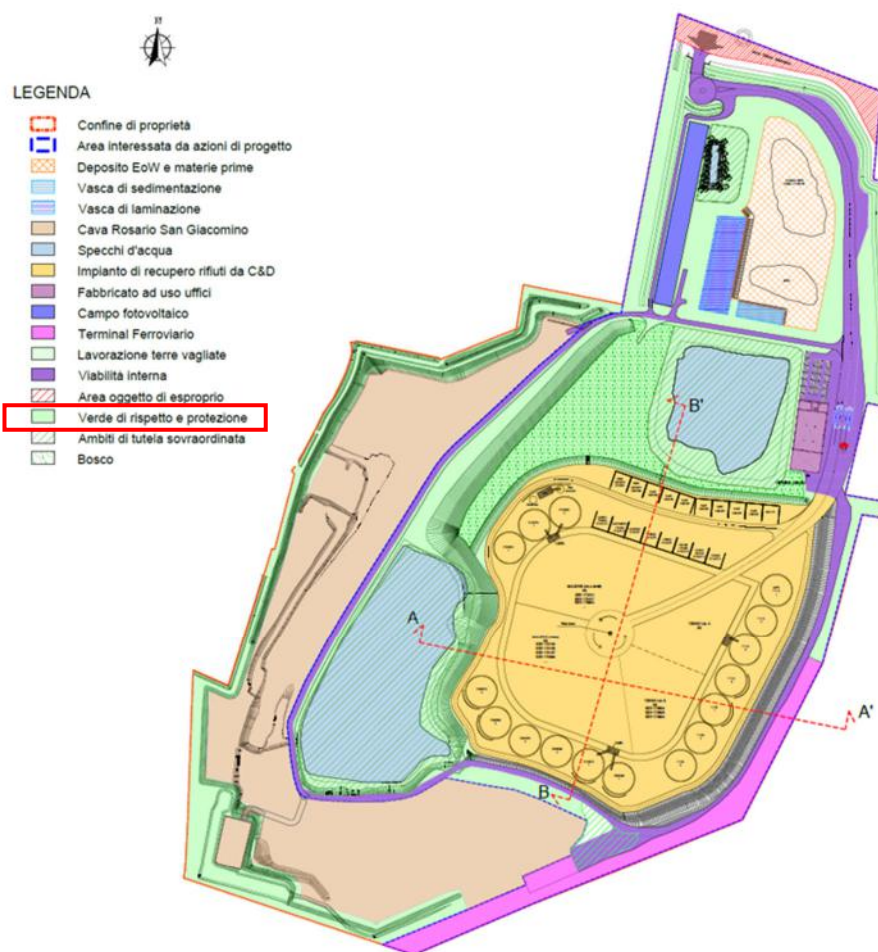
Individuazione verde di rispetto e protezione (stralcio Tav. PF T11)
